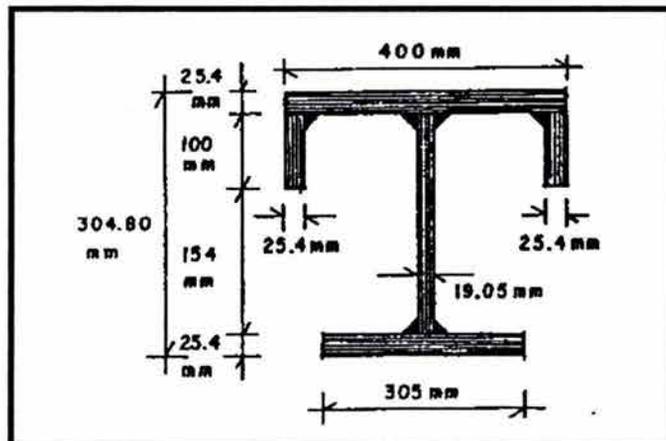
VIGA METÁLICA DE SOPORTE
